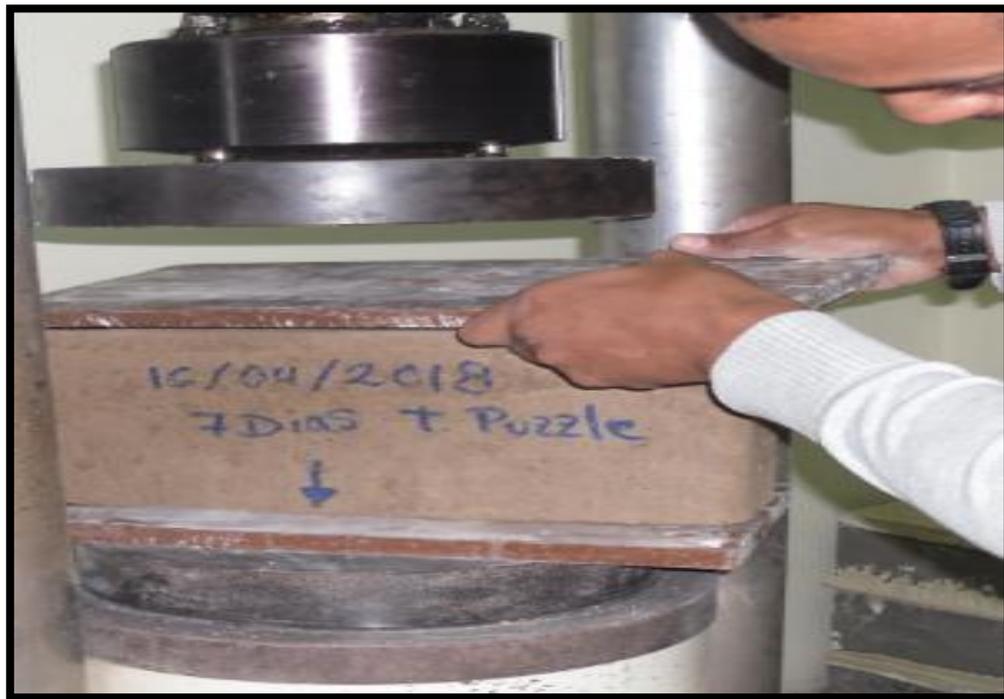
Colocación de placas metálicas y esfera en el centro de las placas
